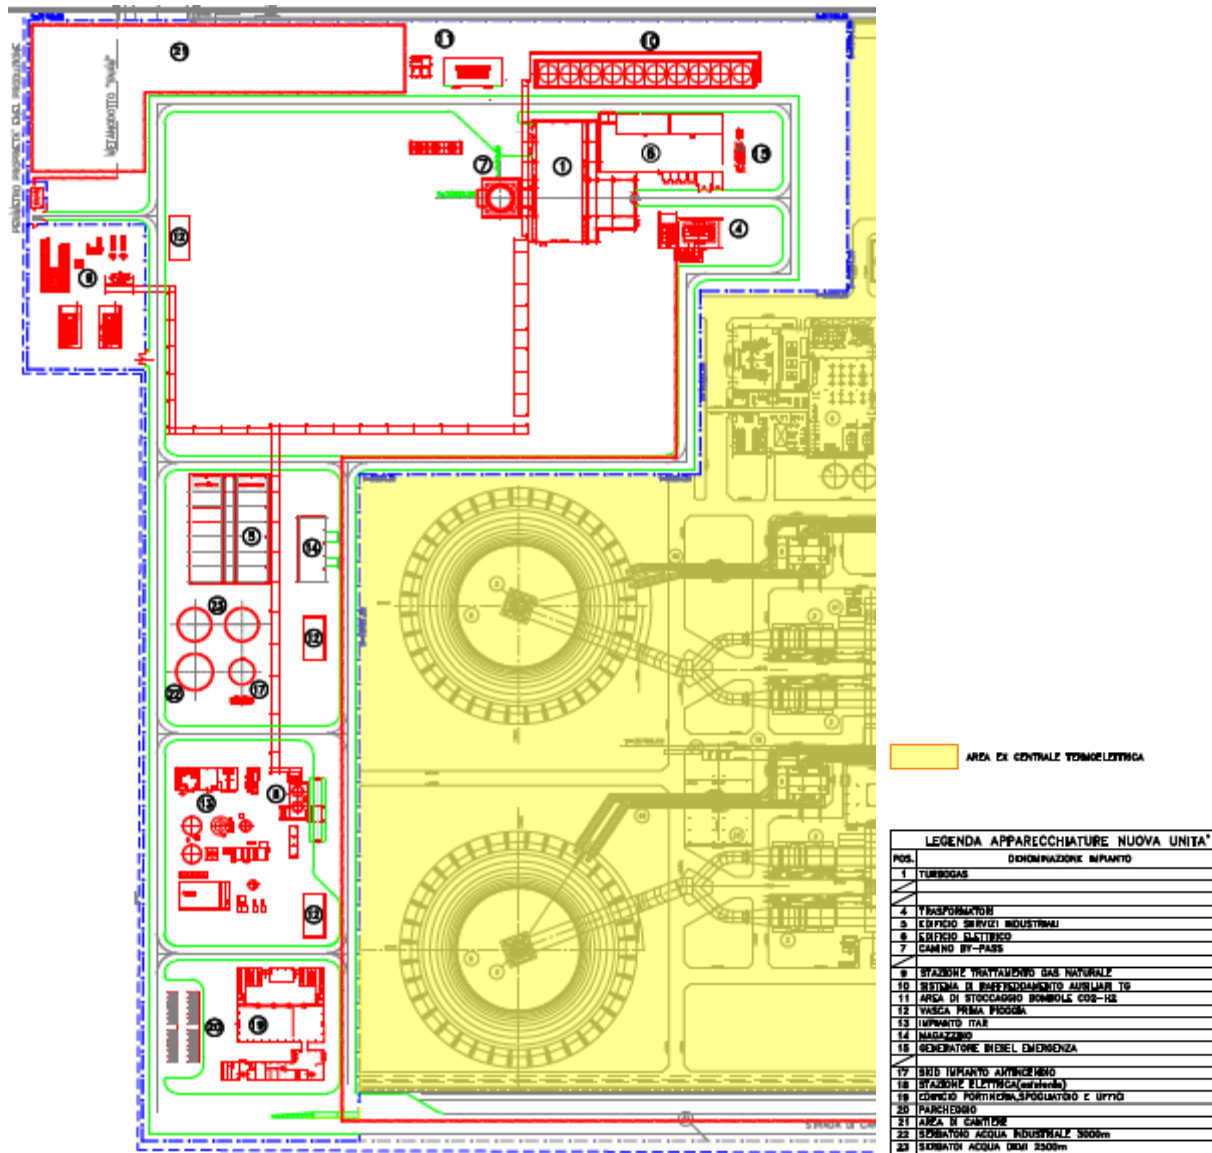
Stralcio della Planimetria della Fase 1 - OCGT
